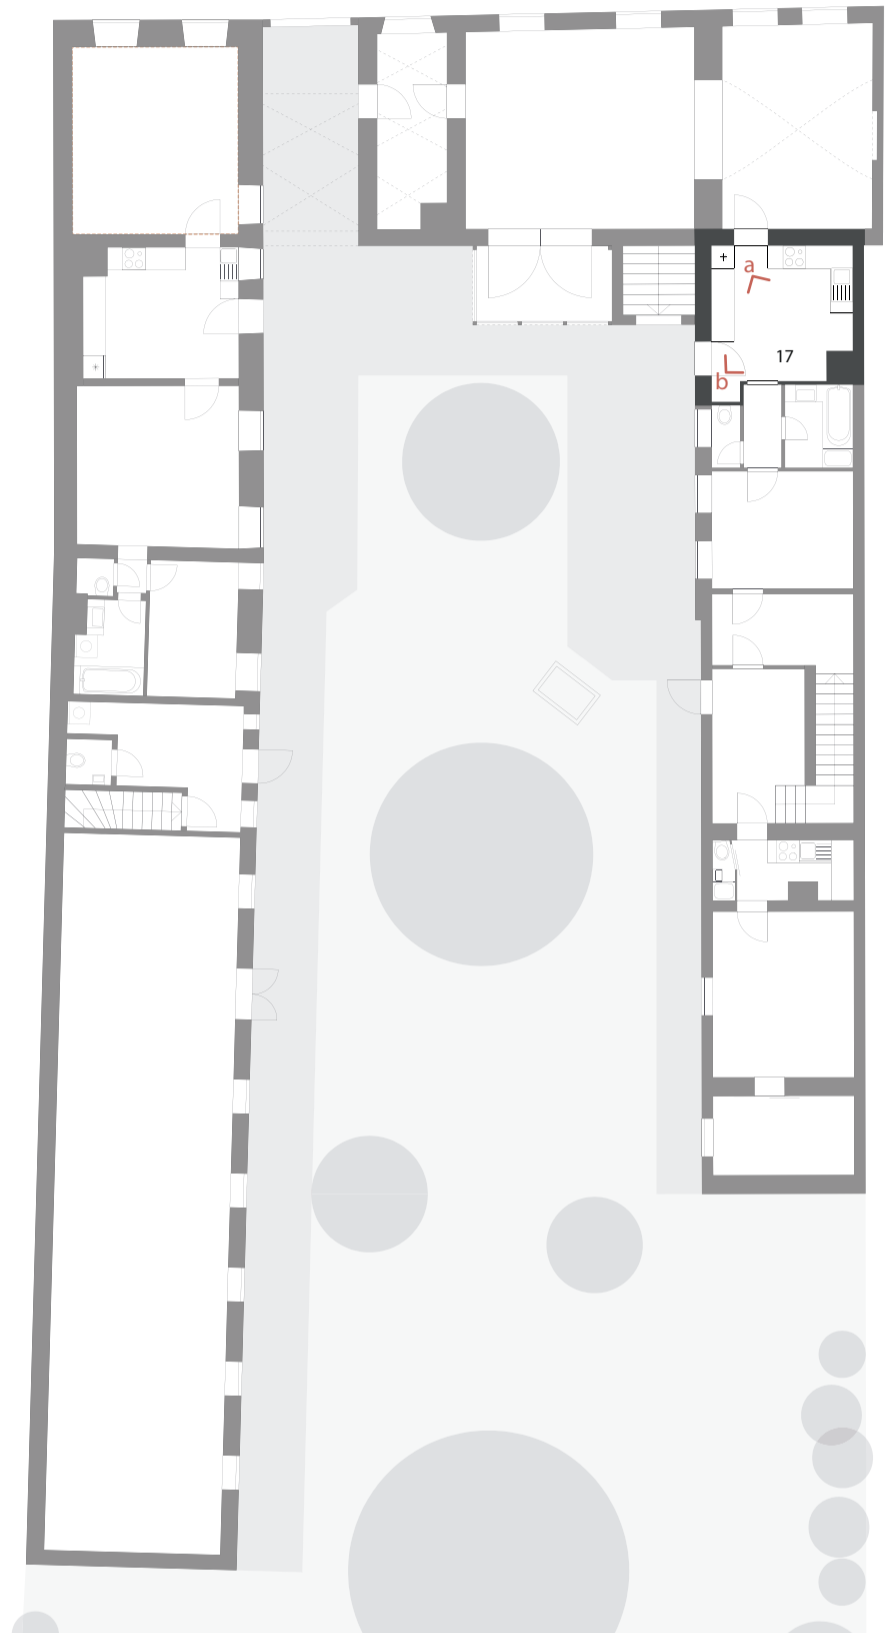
Grundriss Erdgeschoß | M 1:200 | Raum 17
